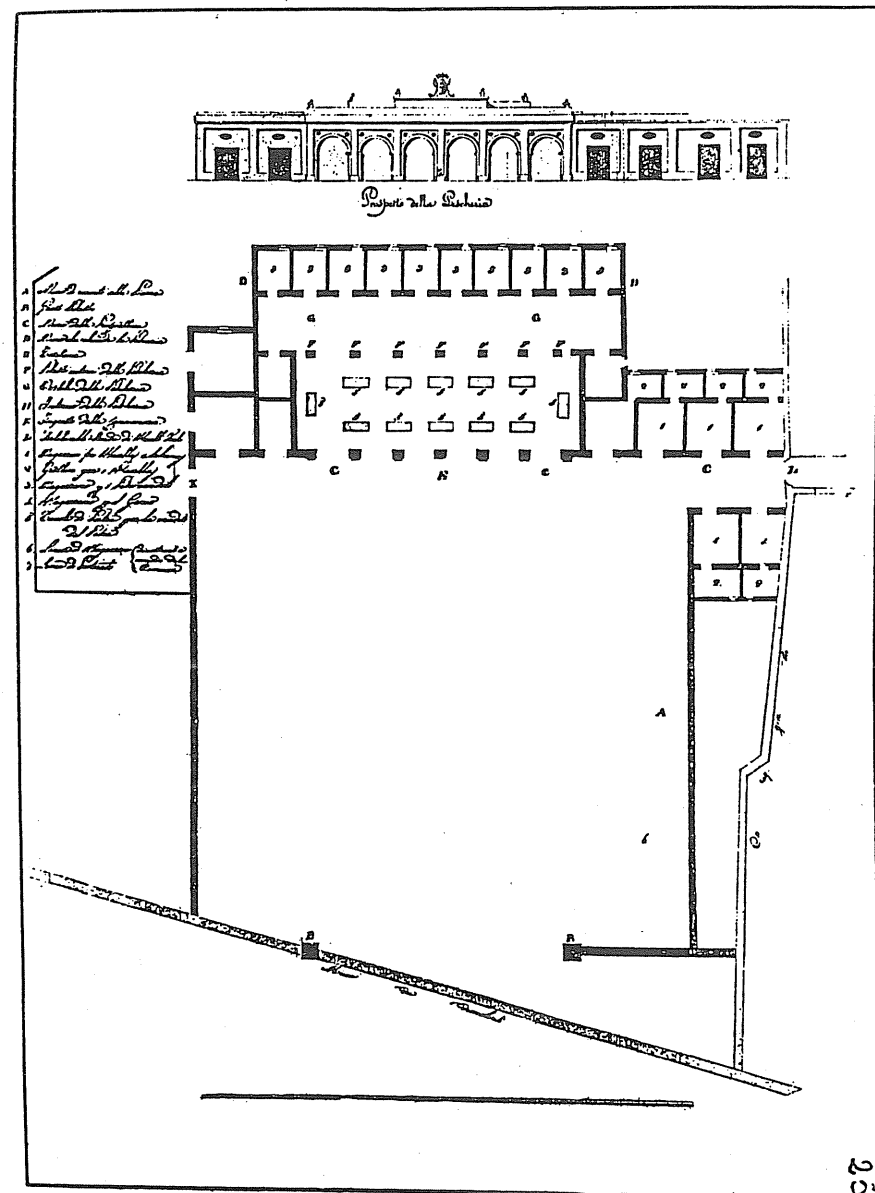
Senigallia (AN): *Foro Annonario*, progetto retto (1831), arch. Pietro Ghinelli, pianta e prospetto.
